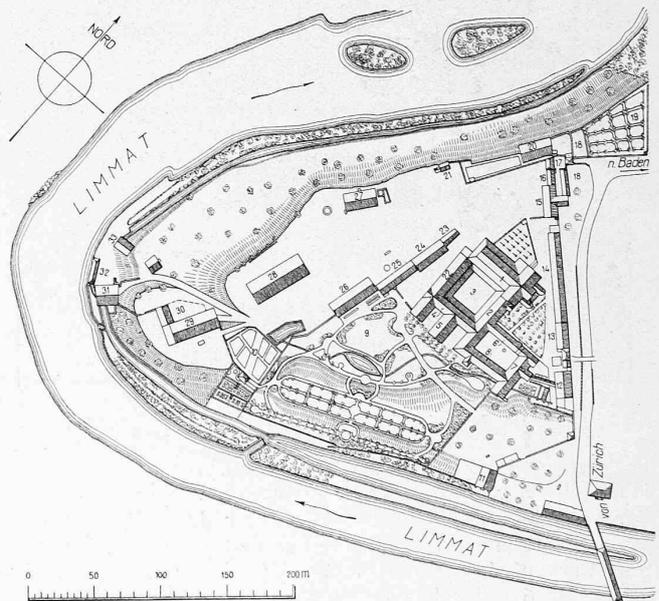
Lageplan des ehemaligen Klosters Wettingen. — Masstab 1:5000.
